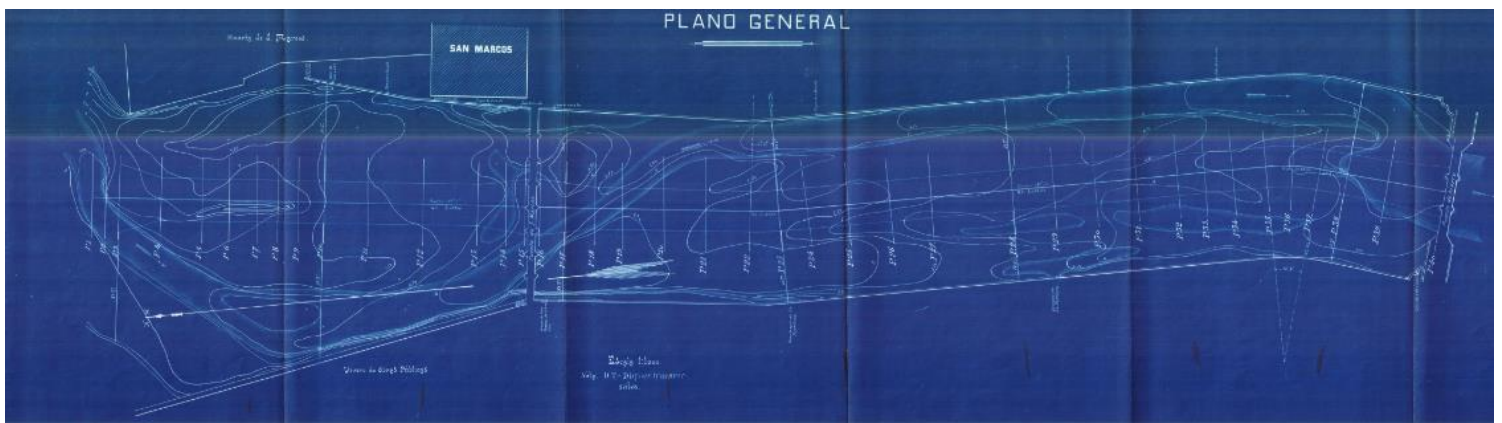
Planta del Proyecto de reparación de la canalización de 1907 (Pérez de los Cobos, 1908). El perfil 27 del proyecto original está situado unos 280 m aguas abajo del puente de San Marcos (Figura 30).
